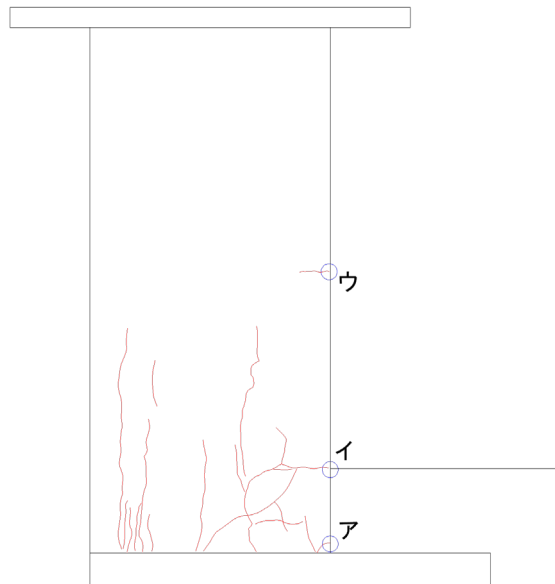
柱ひび割れ幅測定位置(試験体 C-1 負荷荷)
